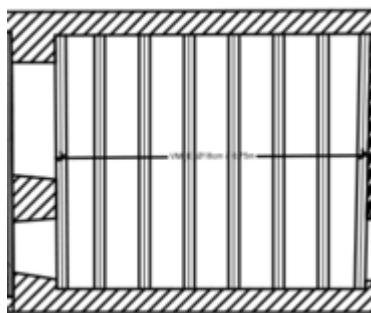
Planta estrutural do pavimento PVRA_4
